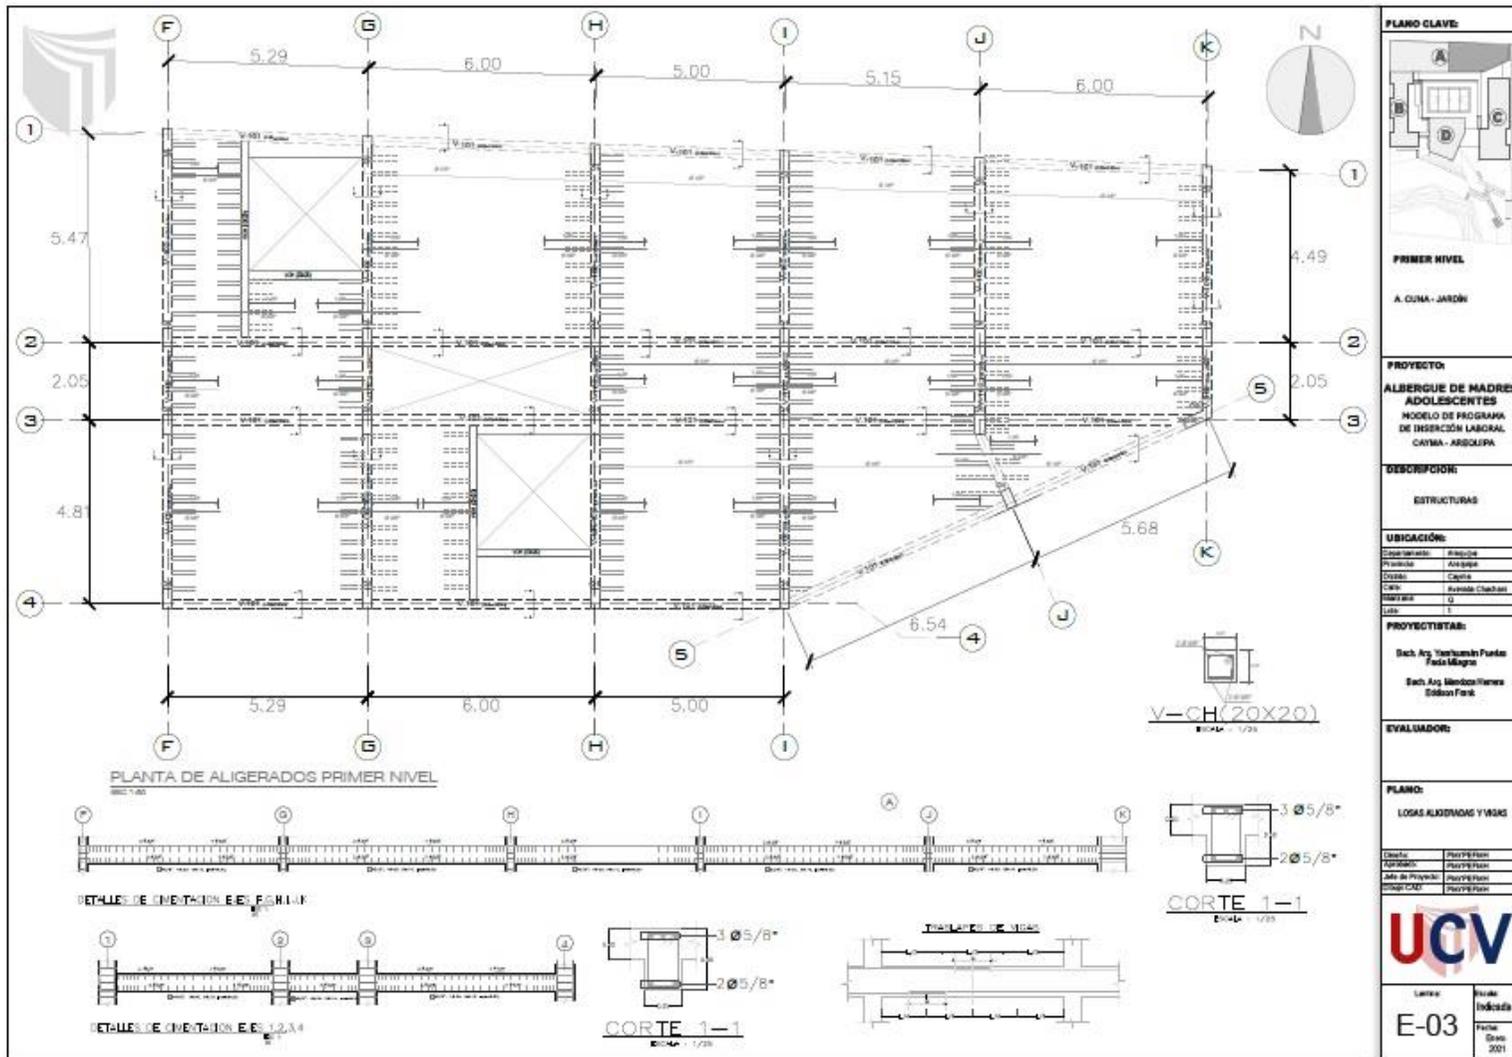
Plano de Estructura de Losa y techos – Sector A – Cuna Jardín E-03.
